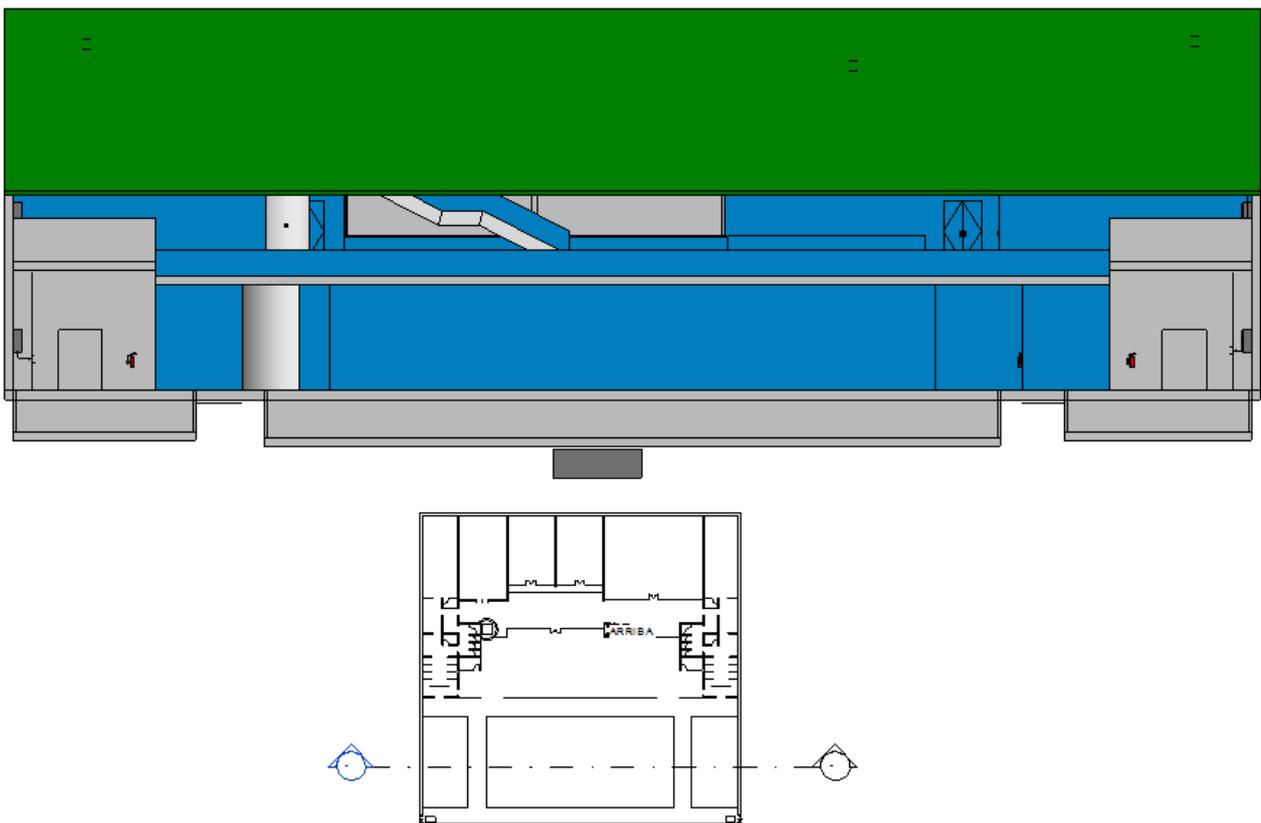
Vista seccionada del alzado sur del edificio. Fuente: Elaboración propia. 2016.
